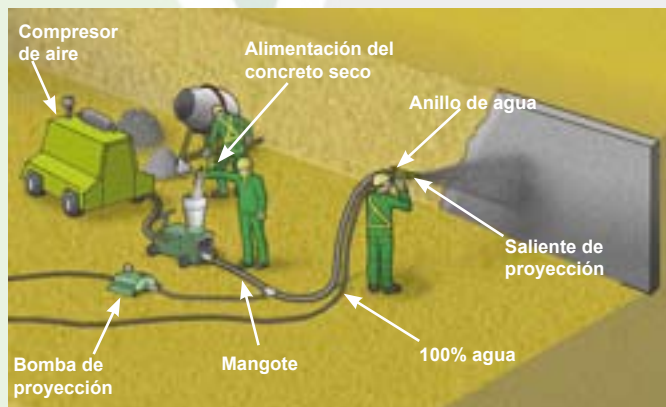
Montaje de la aplicación convencional del hormigón proyectado.
